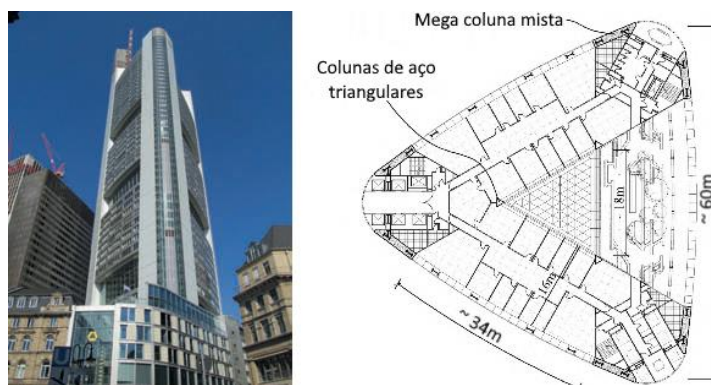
Commerzbank Tower e sua planta baixa com indicação de colunas [6]
